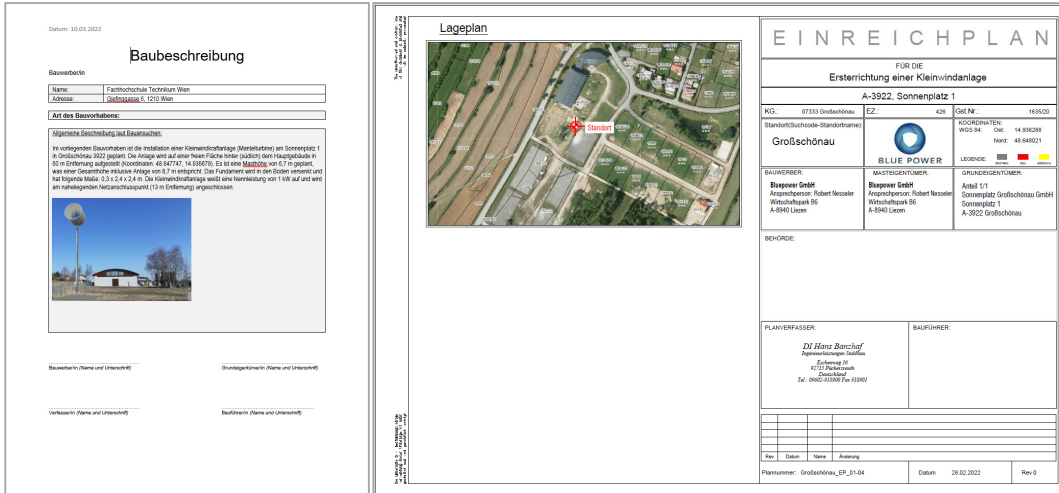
Beispiel Baubeschreibung und Einreichplan
